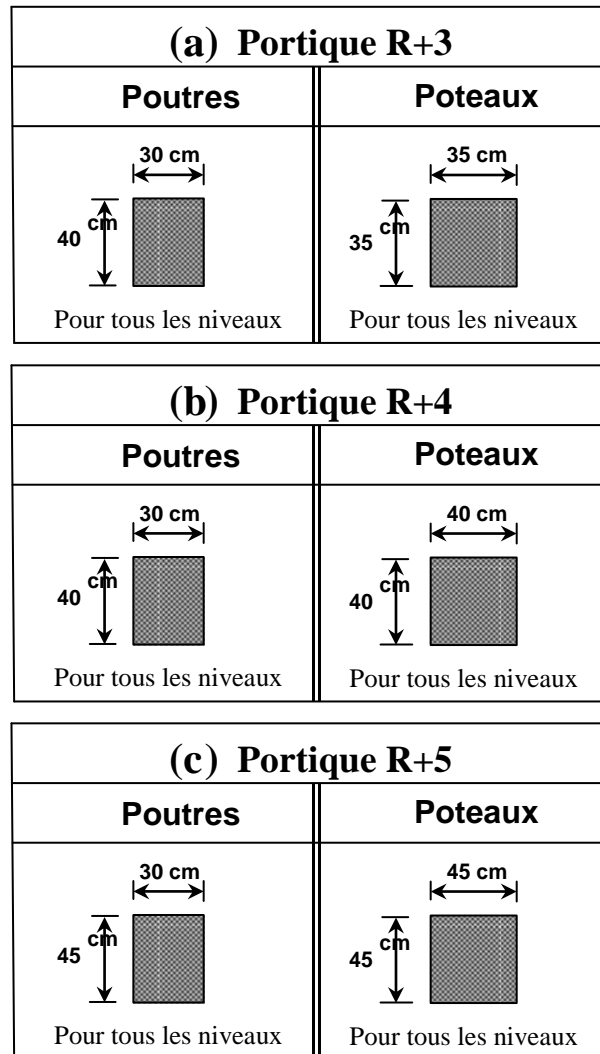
Dimensionnement des sections de béton des poutres et des poteaux des trois portiques étudiés
